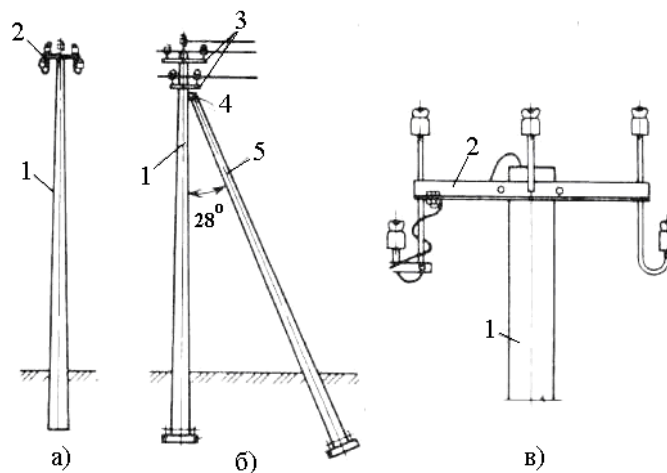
Залізобетонні опори ПЛ до 1 кВ із віброваними стійками:
